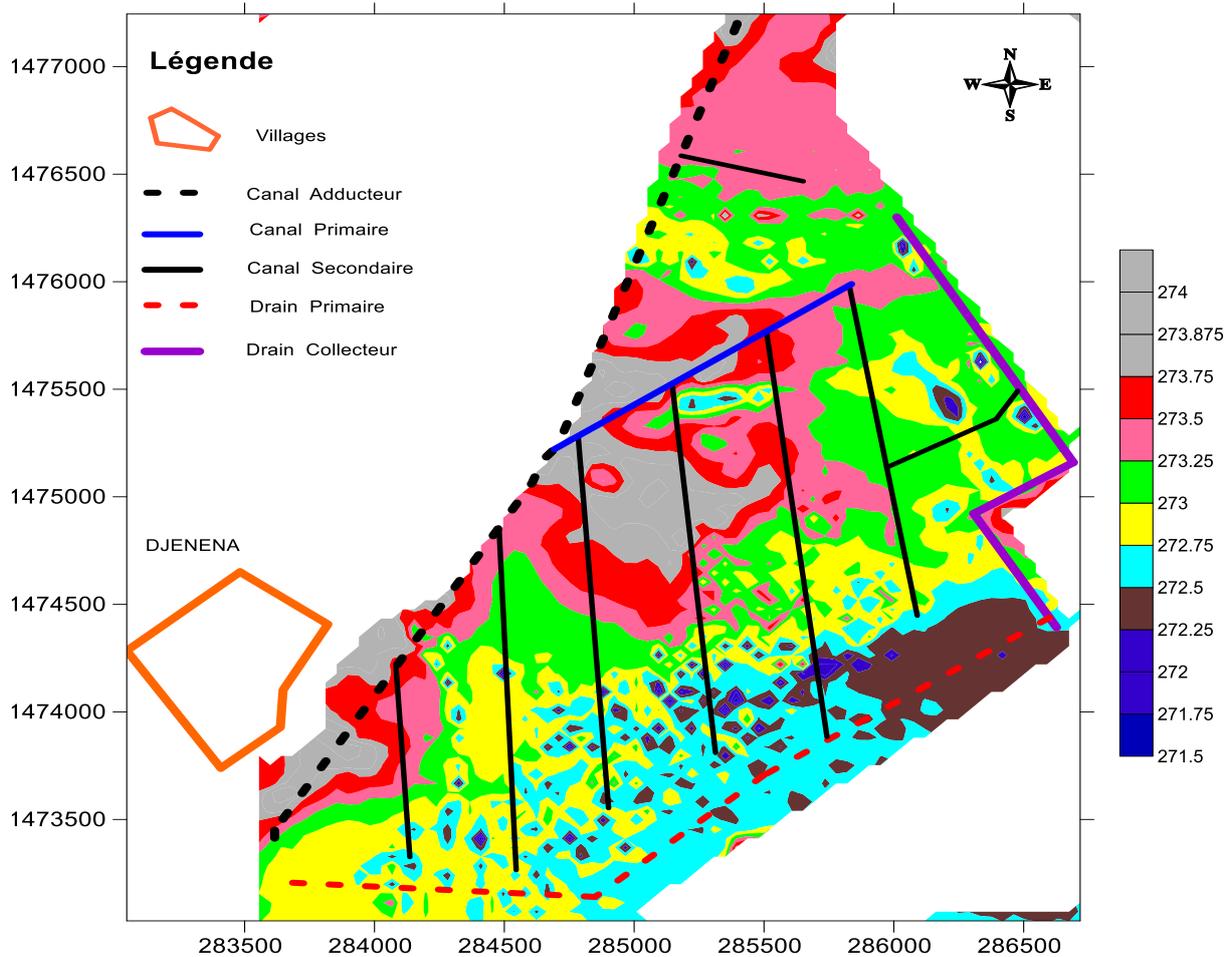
Tracé des canaux (primaires et secondaires) et drains primaires
